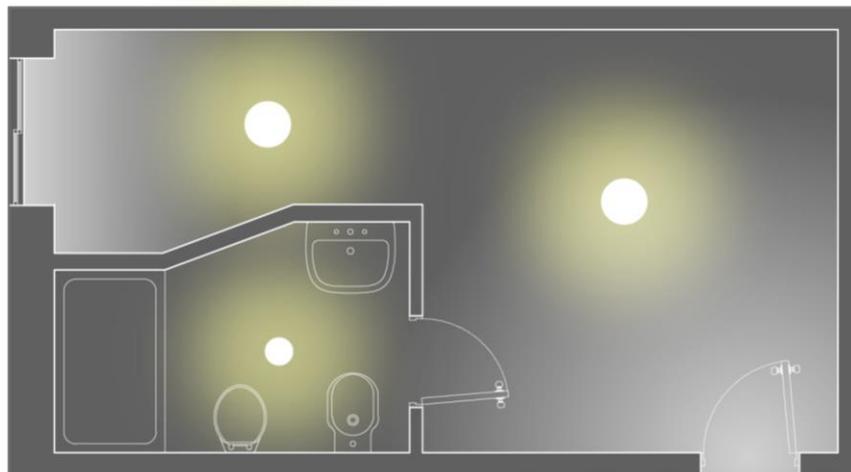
Planta iluminación original caso de estudio. Escala 1:50. Fuente: elaboración propia.
